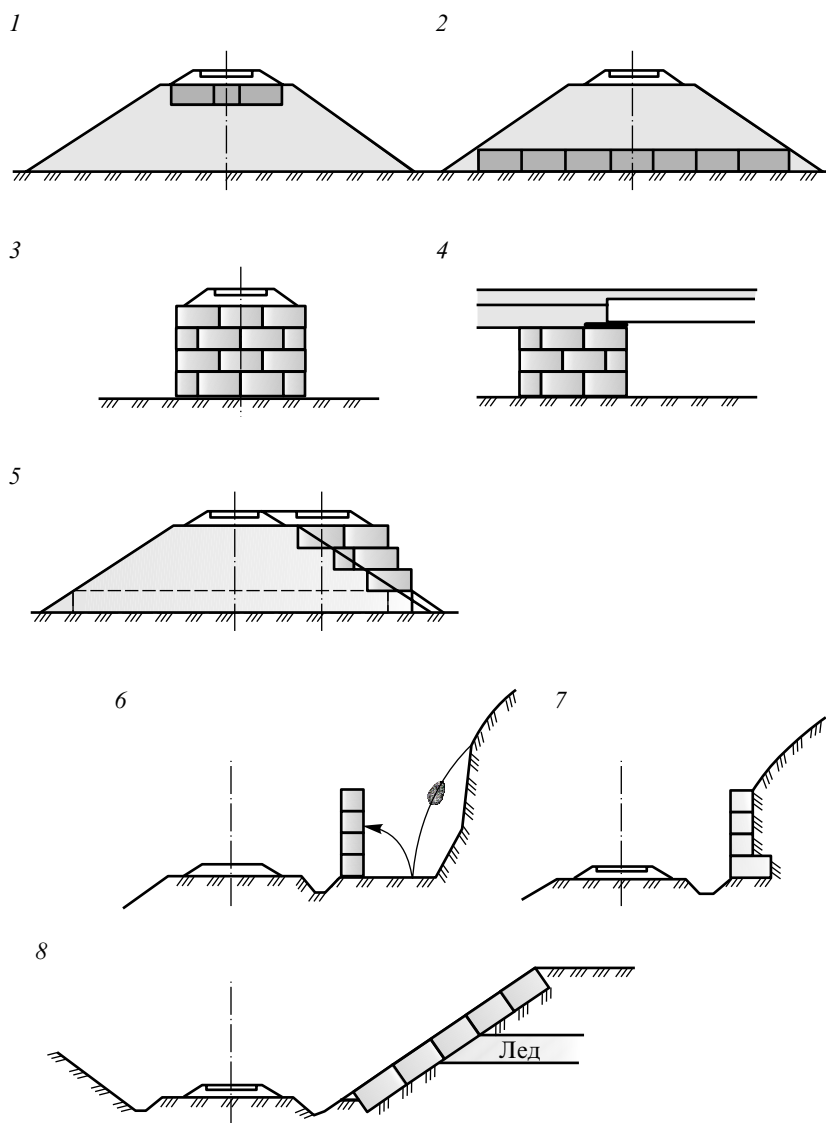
Габионные (из камня) грунтогабионные конструкции:
